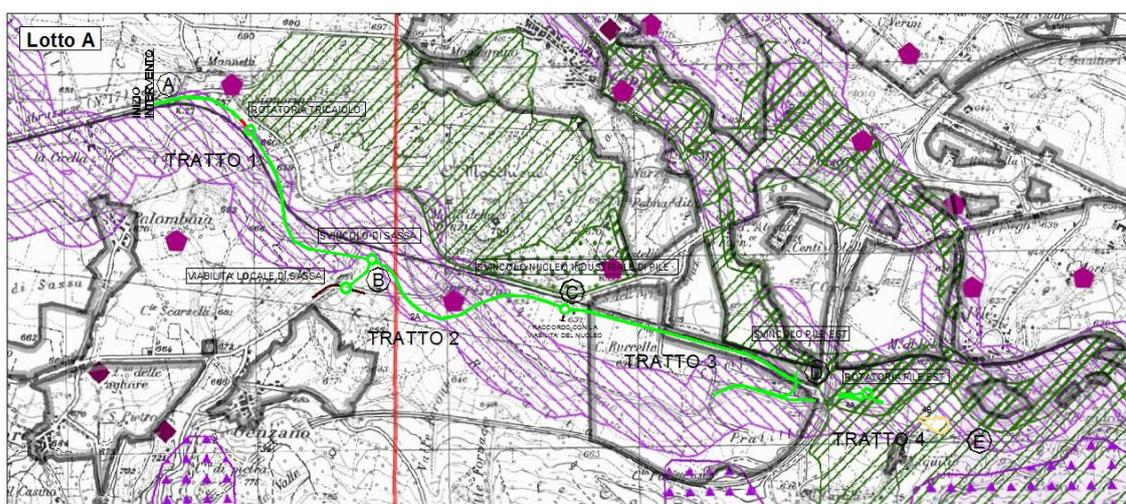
Stralci planimetrici estratti dal P.R.P. in fase di approvazione con evidenza del tracciato di progetto e le alternative progettuali.
